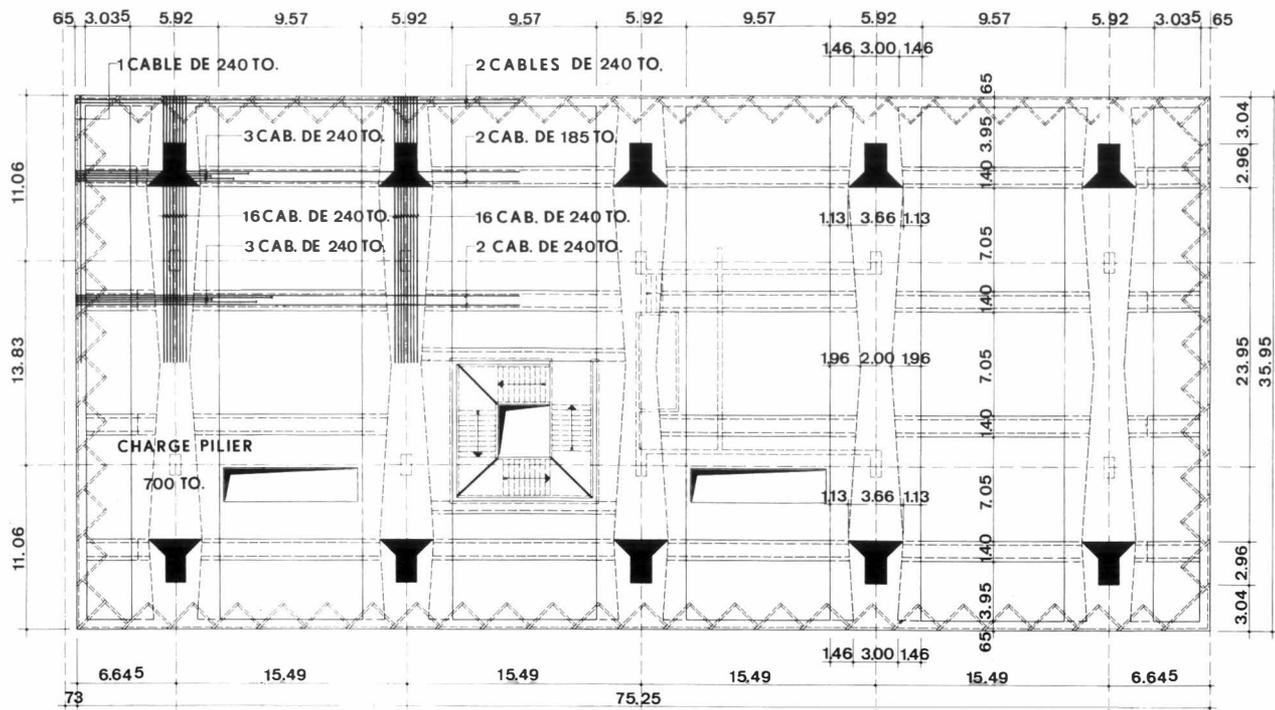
Dalle sur rez-de-chaussée, câblage partiel
